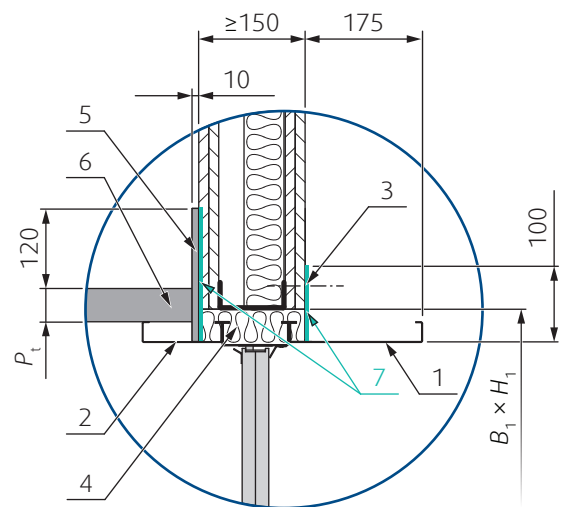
(E190S) Querschnitt eines Einbau ③ mit Trockeneinbau Mineralwolle in einer Leichtbauwand
